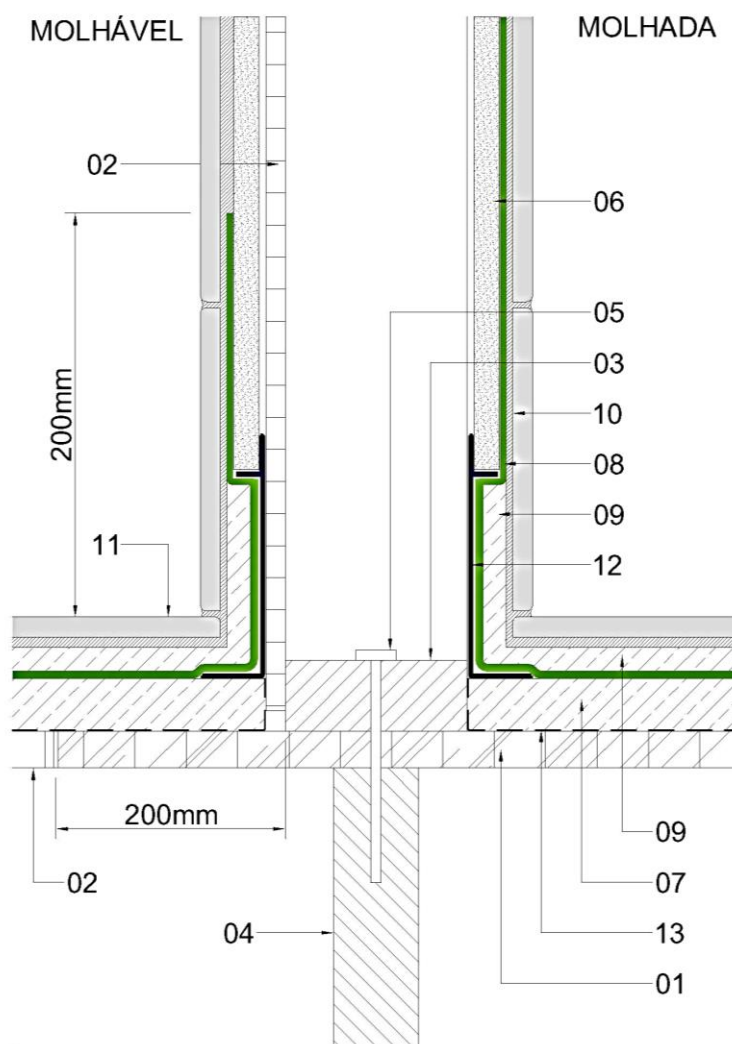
Detalhe de interface entre piso interno de áreas molháveis e base de paredes de fachada (laje plana) – sem escala
